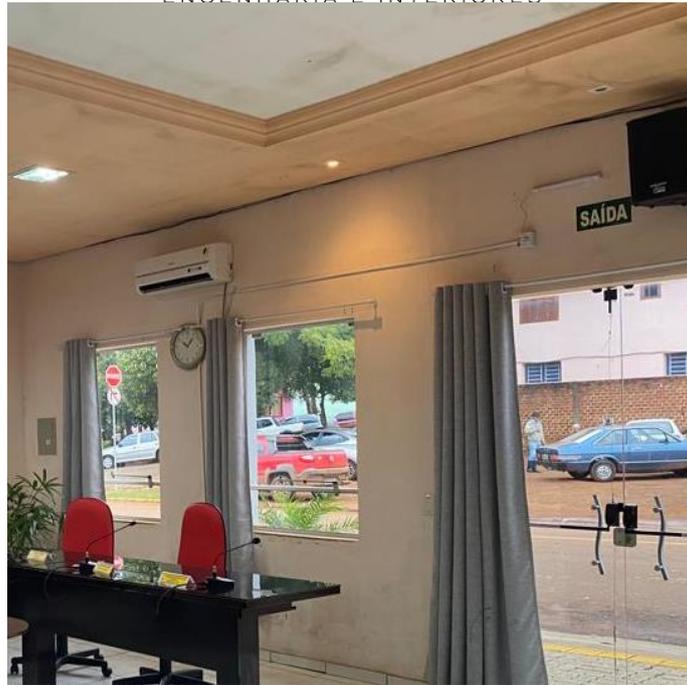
exemplo de fiação a ser conduzida por eletroduto aparente em pvc e tomadas a serem substituídas e instaladas conforme projeto
